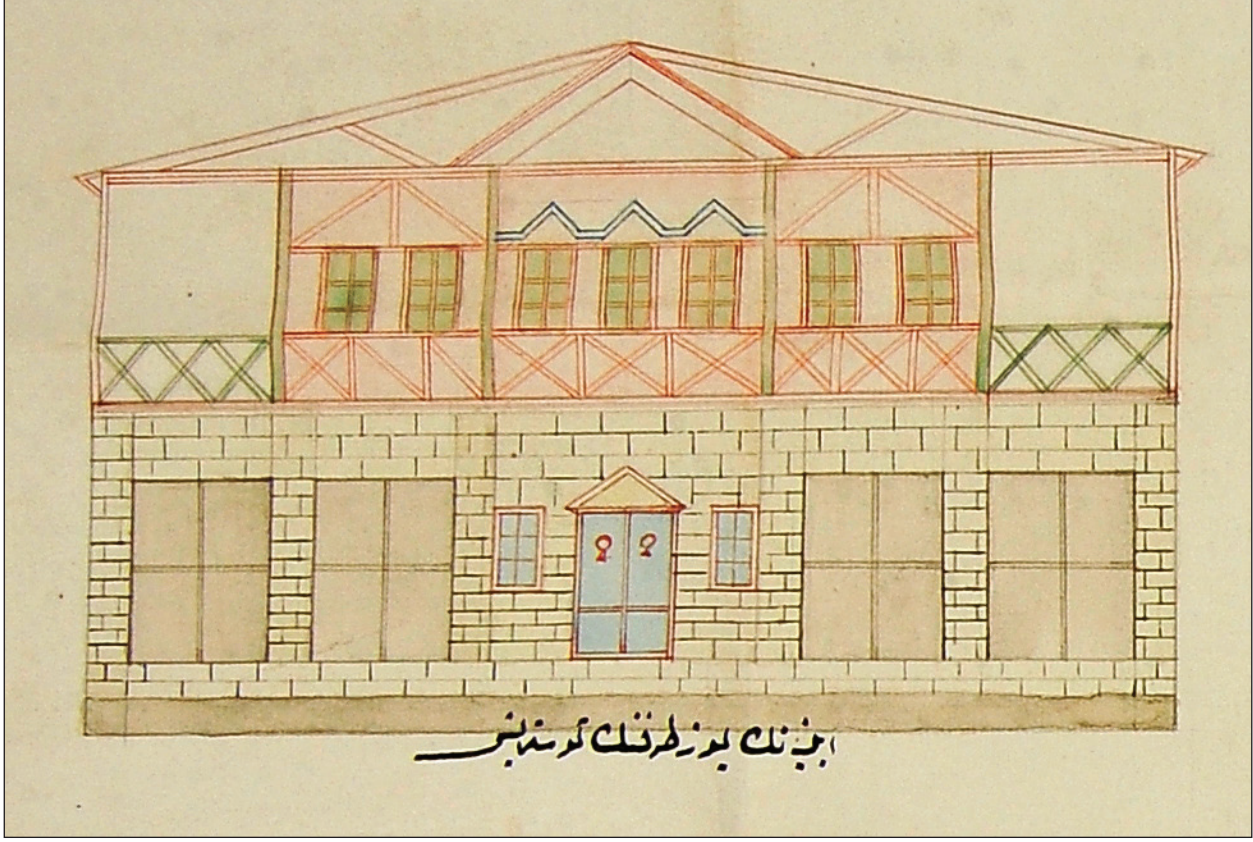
Ankara Belediye Dairesine ait plan ve cephe çizimleri.
